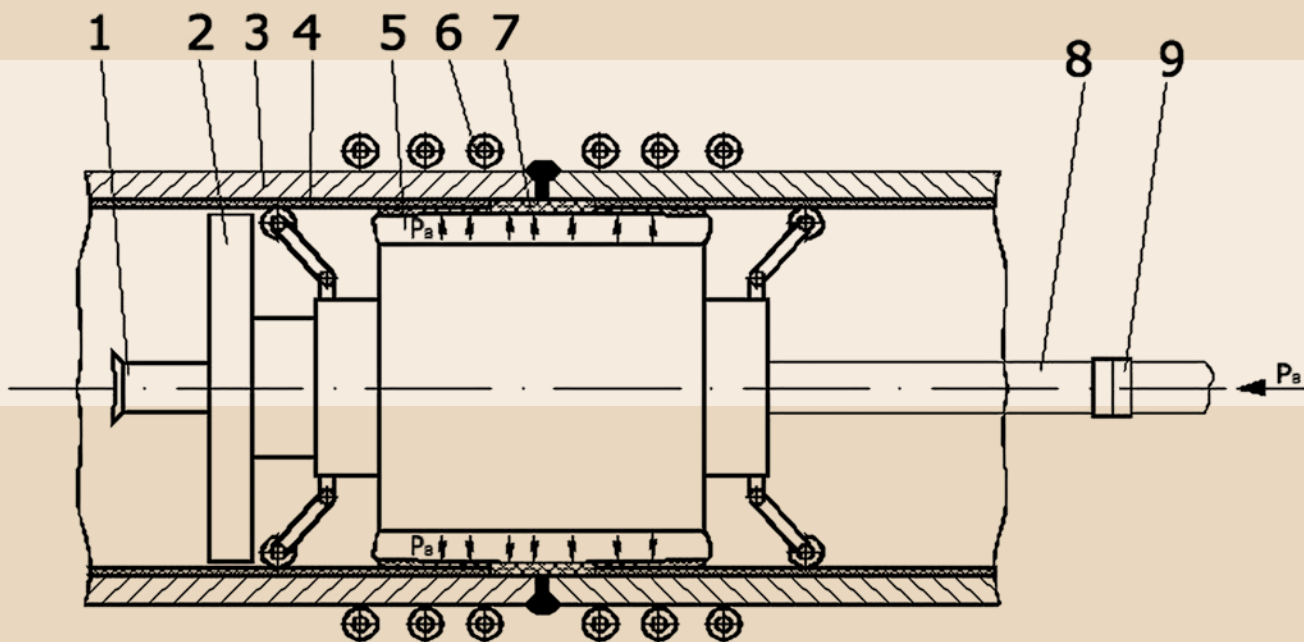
Схема устройства для внутренней изоляции сварного соединения труб с внутренним противокоррозионным покрытием бандажной лентой
